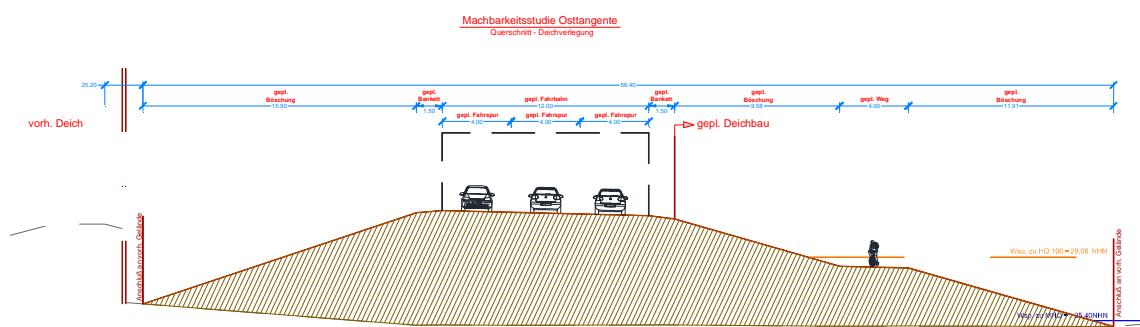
Abschnitt 8, Vorzugsvariante Trasse T1
